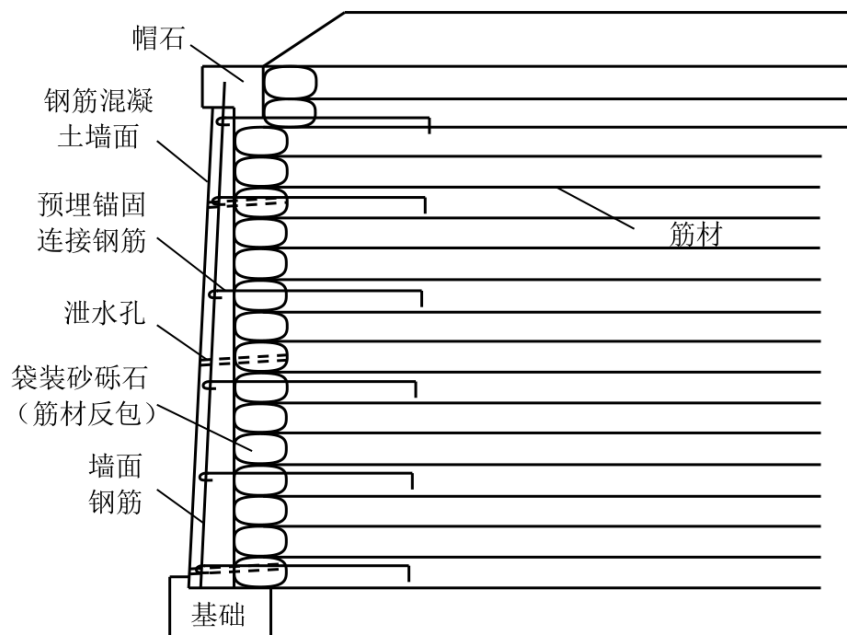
整体现浇混凝土板式墙面加筋土挡墙示意图
